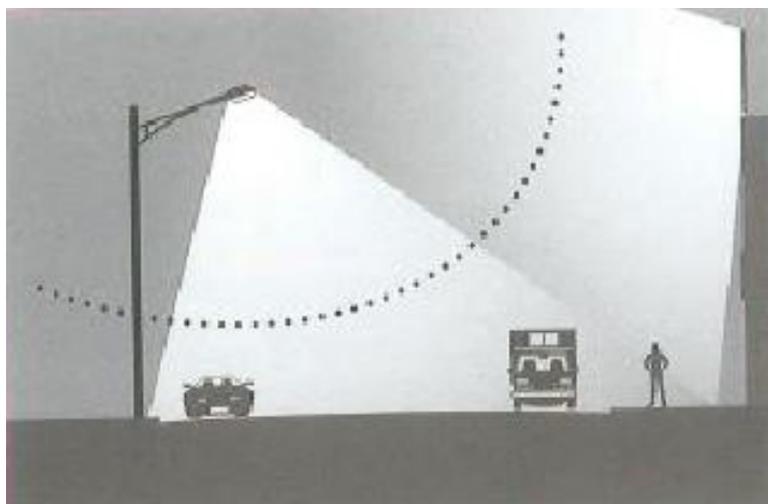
exemple d'éclairage avec luminaires routier ou fonctionnel (source : AFE)
